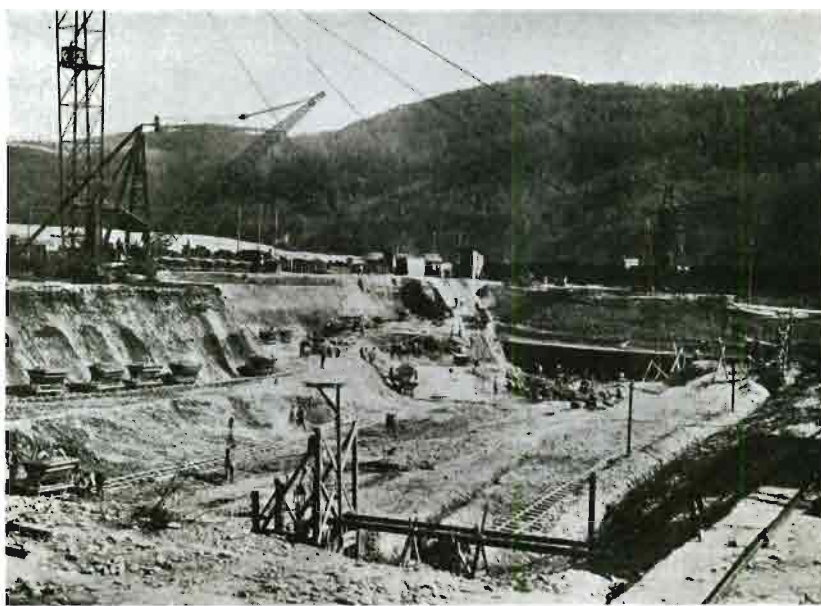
Ogólny widok placu budowy — stan dn. 5.X.1936; na lewo zabudowania warsztatowe, w środku fabryka betonu, wyżej kolonia budynków stałych; wykop zamknięty ścianą Larsen'a.
